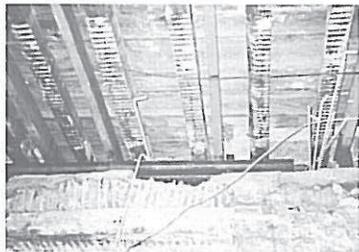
Reforço de pavimento de madeira com vigas de aço.
